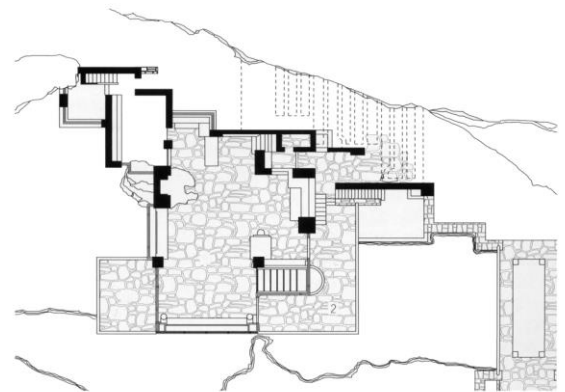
Planta Casa de la Cascada. Fuente: ArchDaily.
